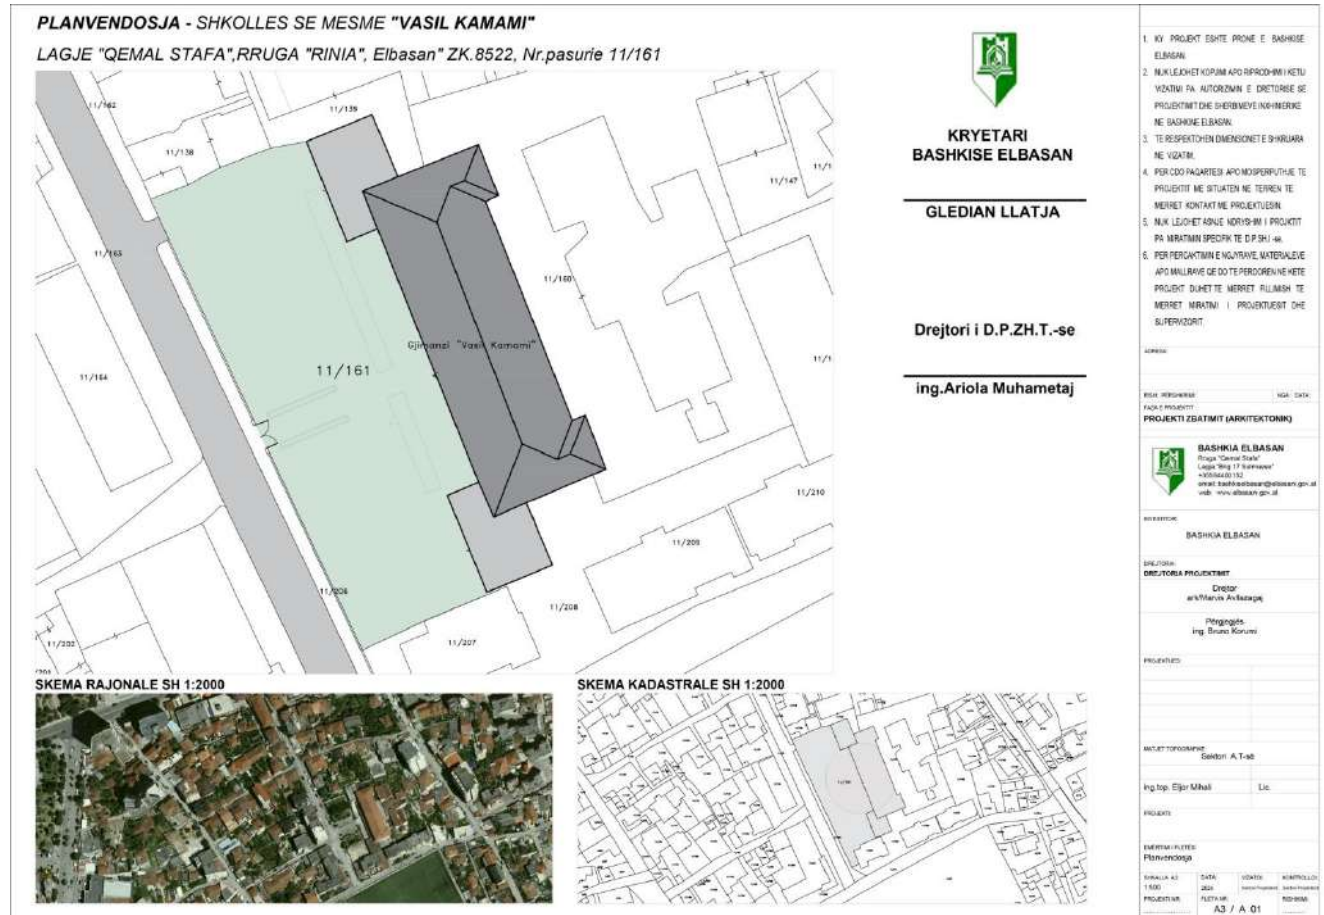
Pozicioni i objektit në hartë kadastrale - plan rilevimi
